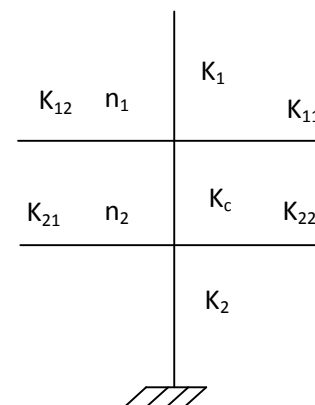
La rigidité des poutres et des poteaux sens Y-Y
